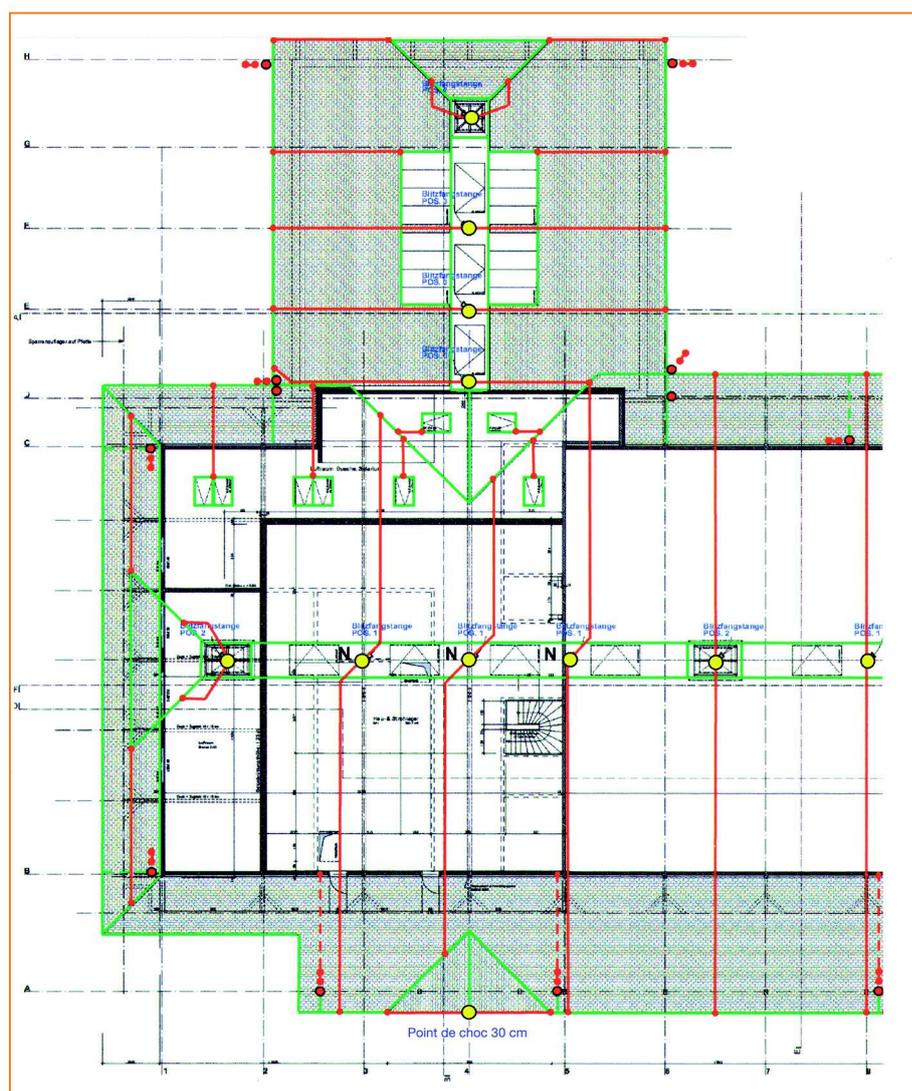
Coupe du concept de la protection extérieure contre la foudre.
